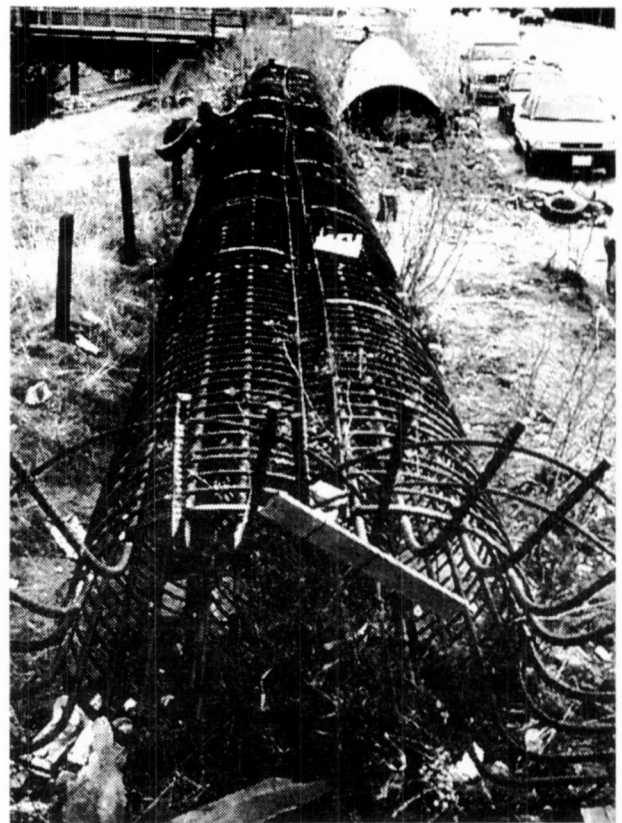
インターロッキング橋脚の配筋 (米国カルフォルニア州)
